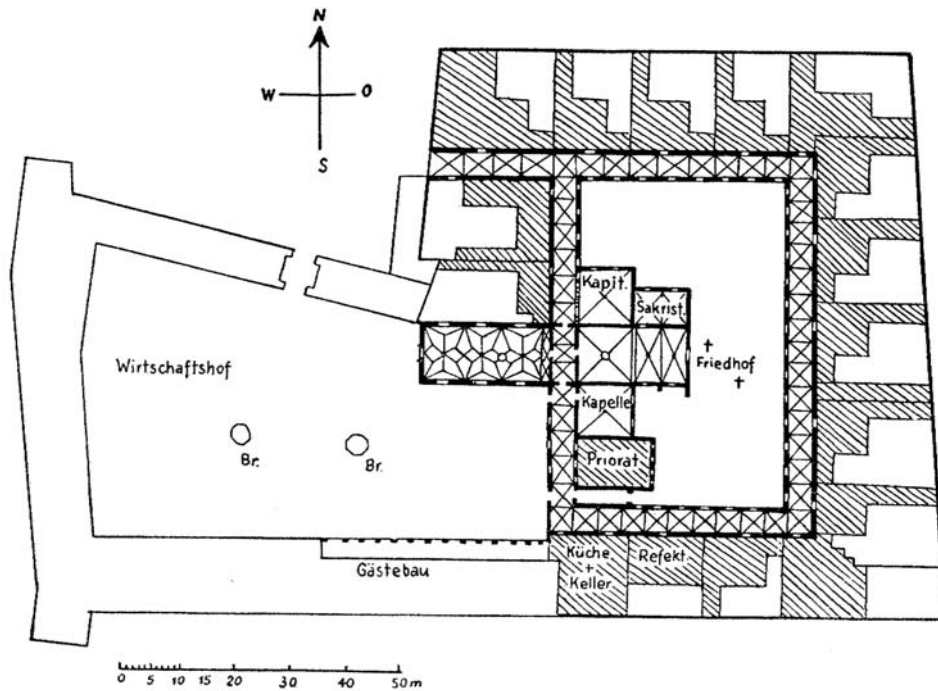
Grundriss der Kartause Tüchelhausen mit durchlaufendem Kreuzgangletztner Gründung 1351
